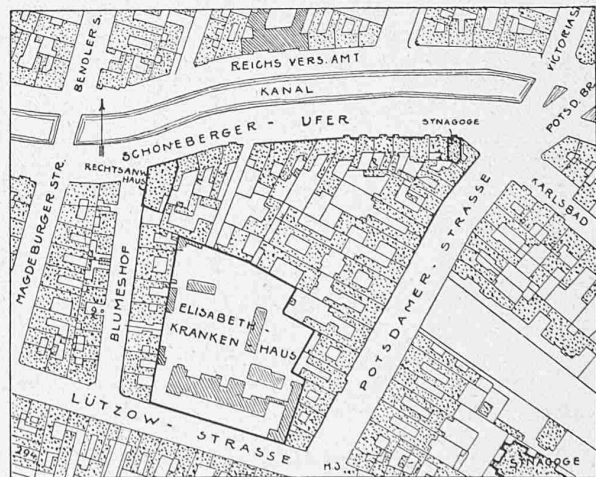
Bestehender Baublock am Landwehr-Kanal in Berlin. — 1:6000.
